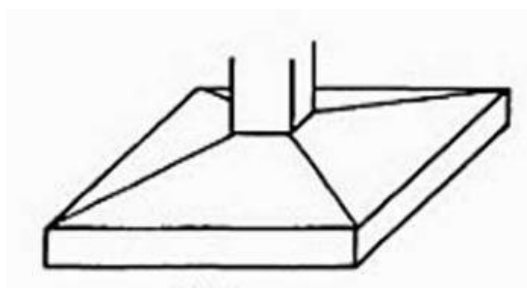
Fundação Rasa - Sapata (VELLOSO; LOPES, 1998).
